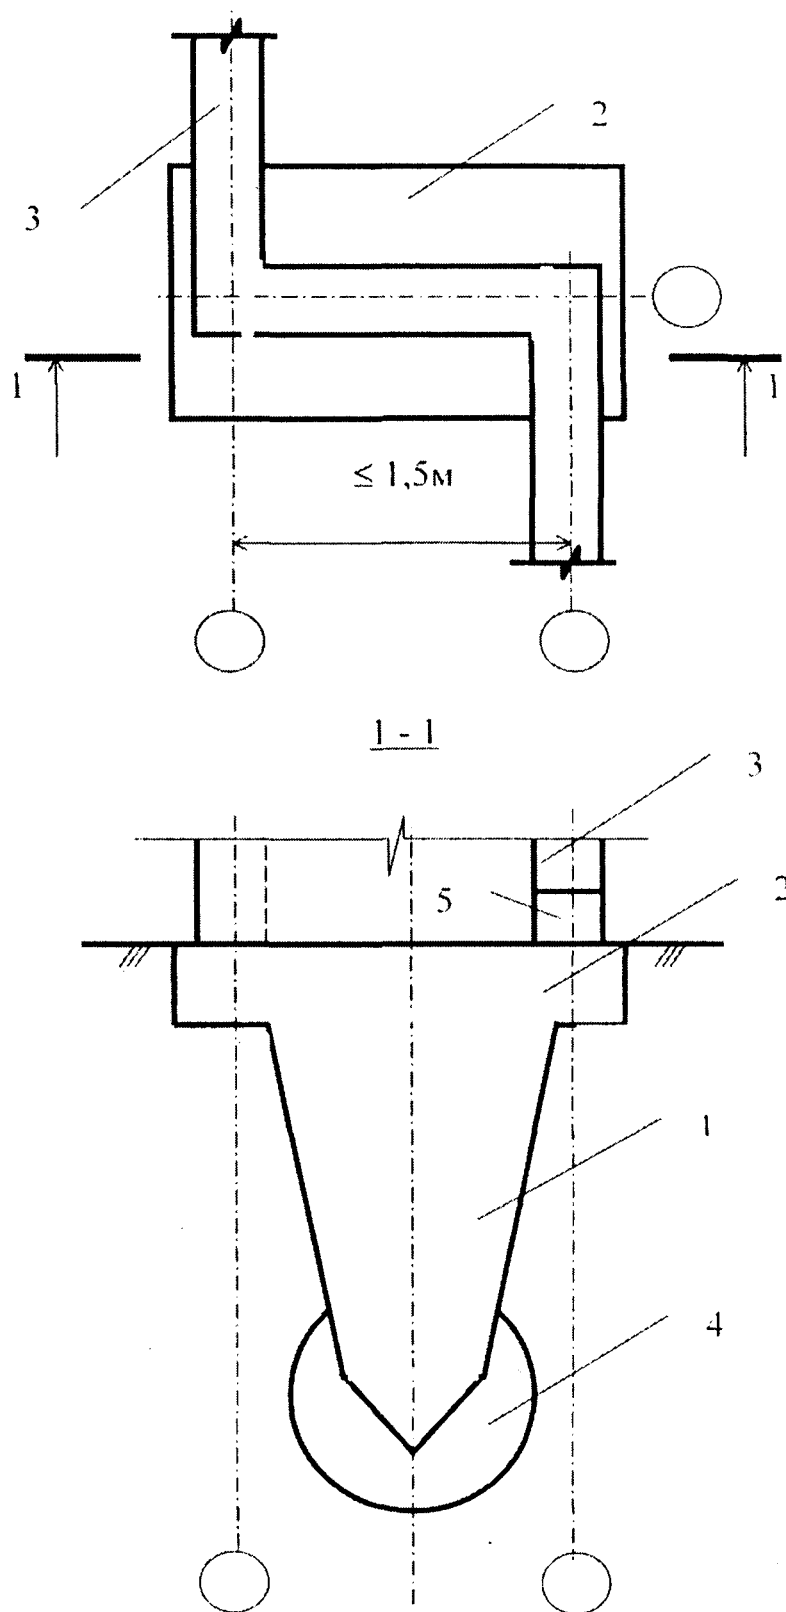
Схема фундамента в вытрамбованном котловане на месте пересечения стен.
